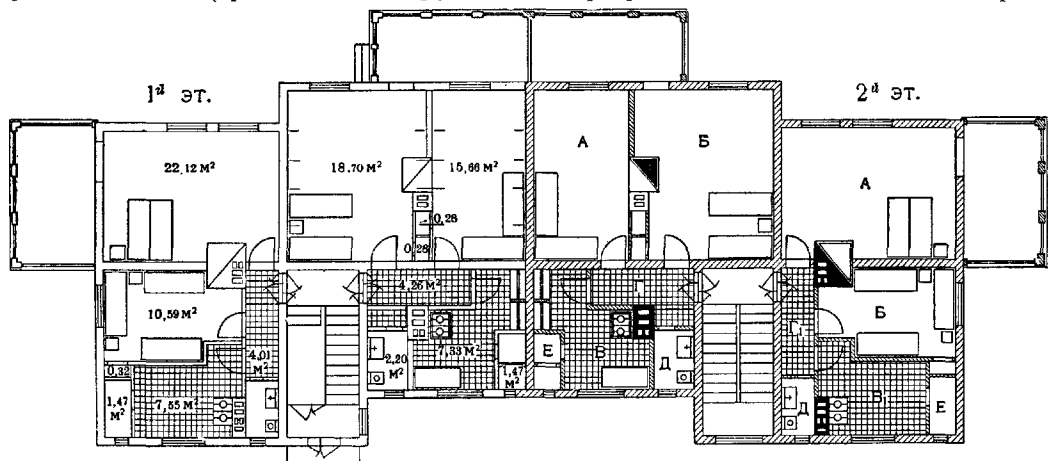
План отдельного деревянного 2-этажного жилого дома в поселке. 8 квартир по 2 комнаты с жилой площадью в 32,7—34,4 м² при ориентации жилой площади на юг (из альбома ЦКБанка). А и Б—жилые комнаты; В—кухня; Г—передняя; Д—уборная; Е—кладовая.
